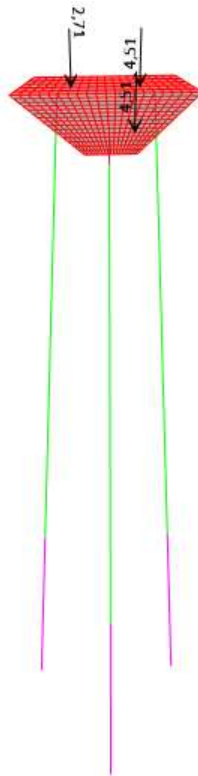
Beban Pipa Kosong (DPE) yang diterima Struktur *Catwalk* 12
